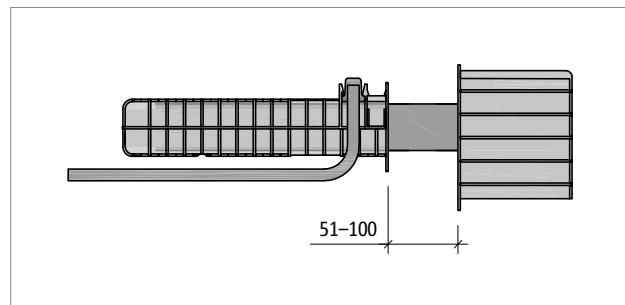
Schöck Tronsole® Typ Q...-XL: Einbauvariante Fugenbreite 51–100 mm
